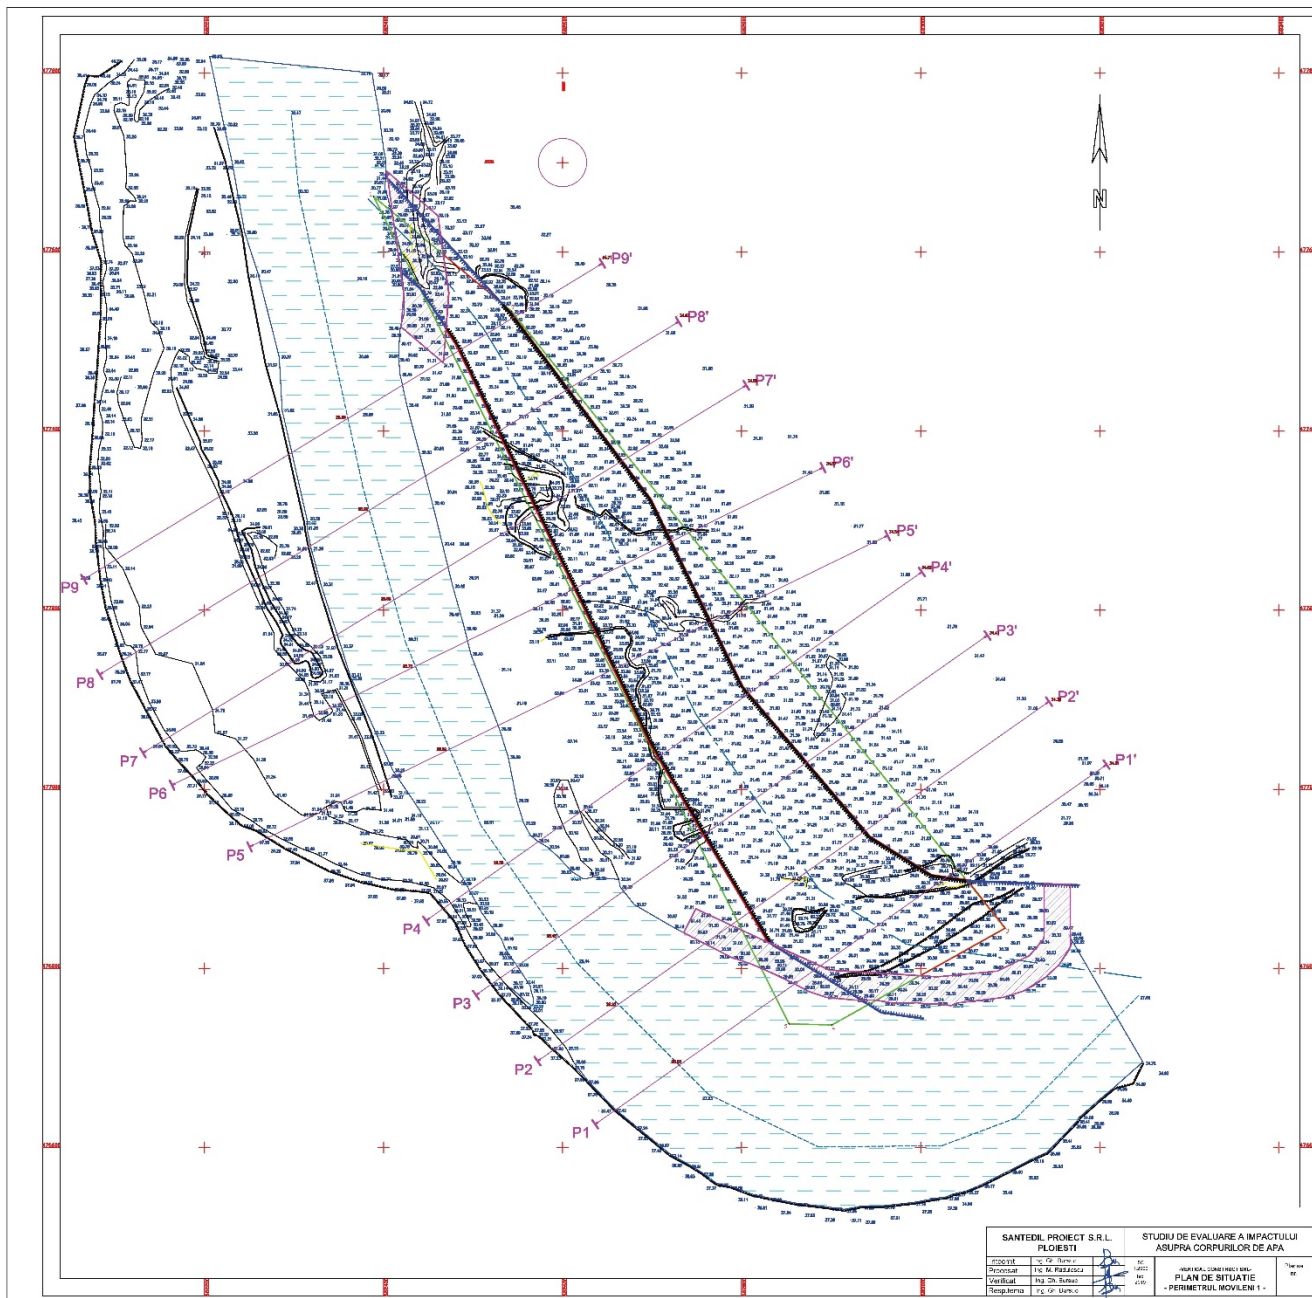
Plan de situație – Perimetrul Movileni 1
